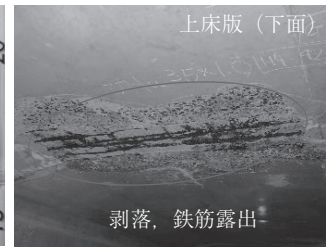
粗骨材の状況 写真-7 H橋の損傷状況
